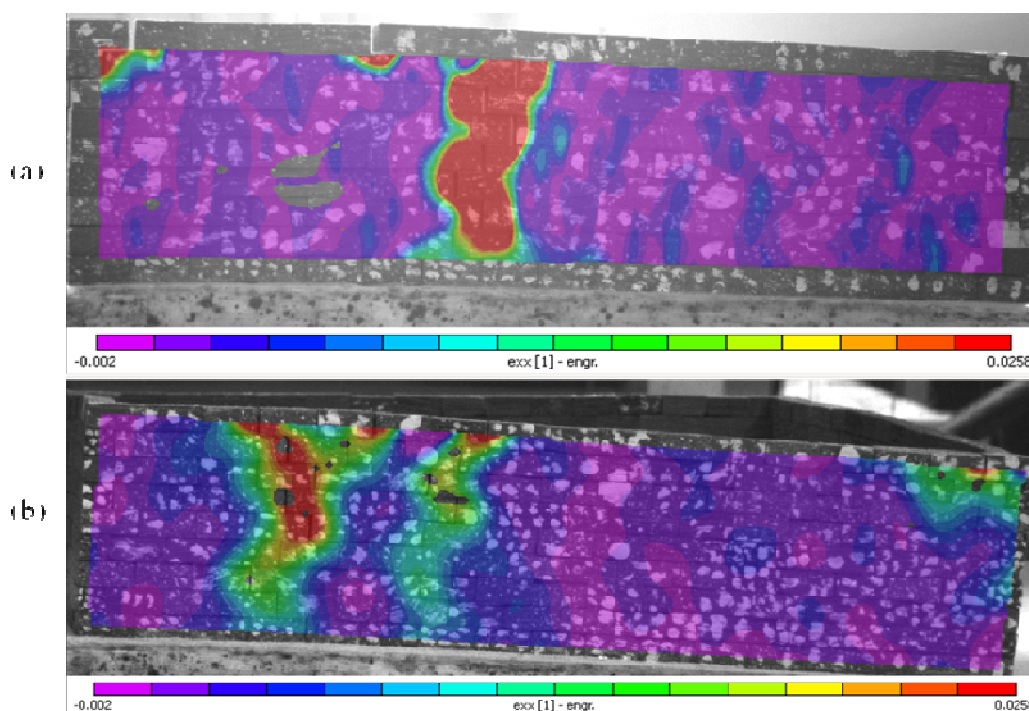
Position  $P_1$  : comparaison de la distribution des fissures en cas de la maquette de la structure (a) sans sable (essai au bureau) et (b) avec le sable (essai sur la plate-forme).
